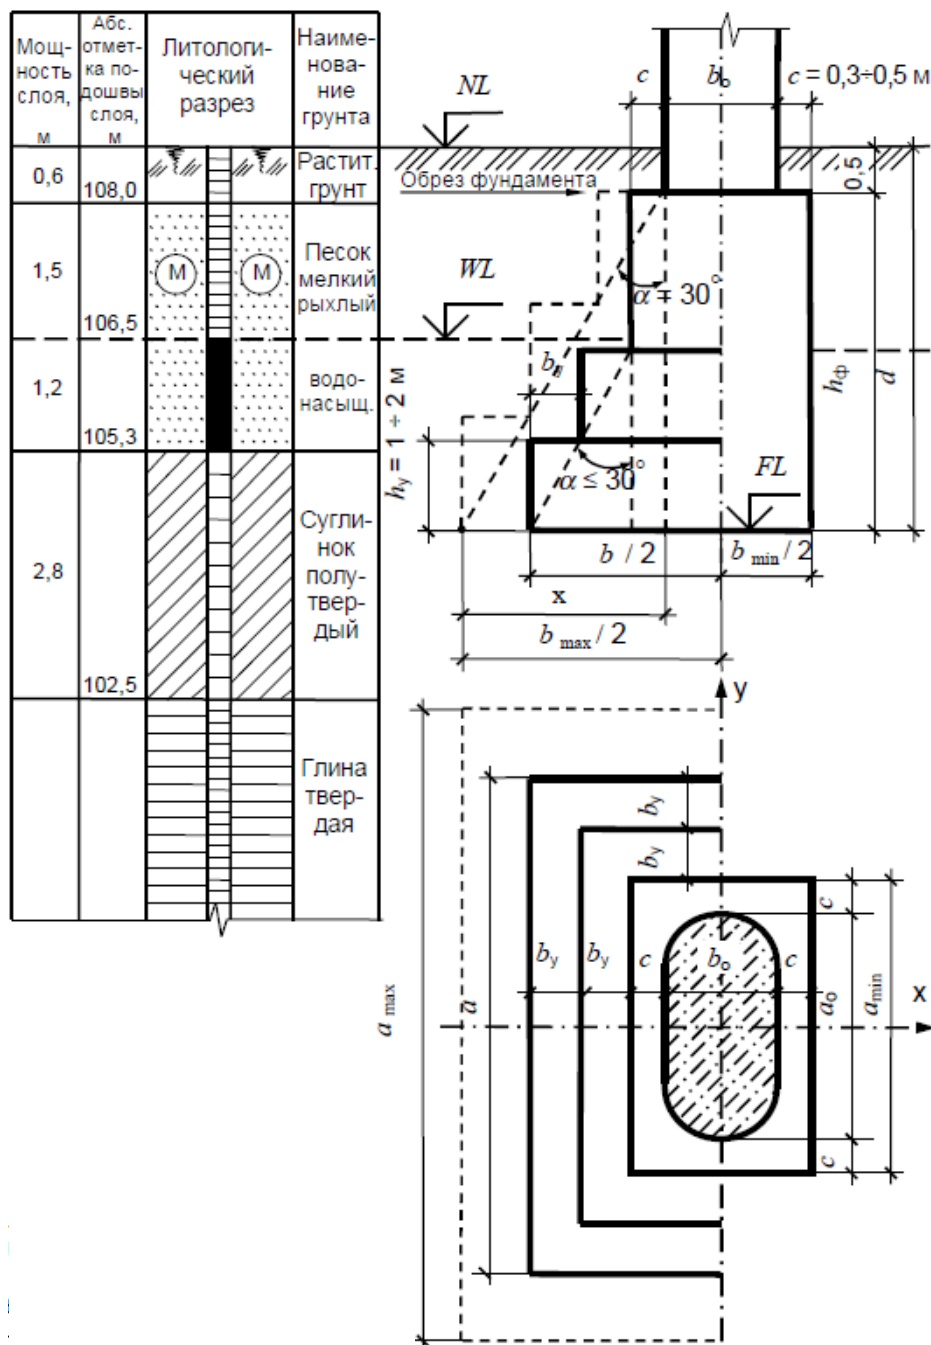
Вариант конструкции фундамента мелкого заложения
